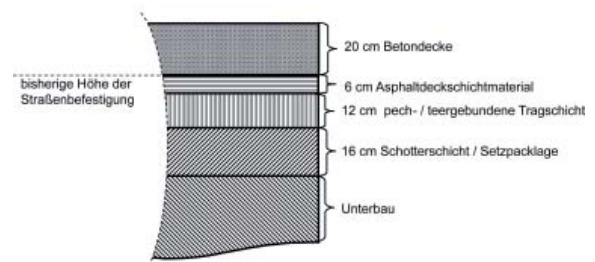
Schnittbild einer Straße nach Überbauen mit Beton
